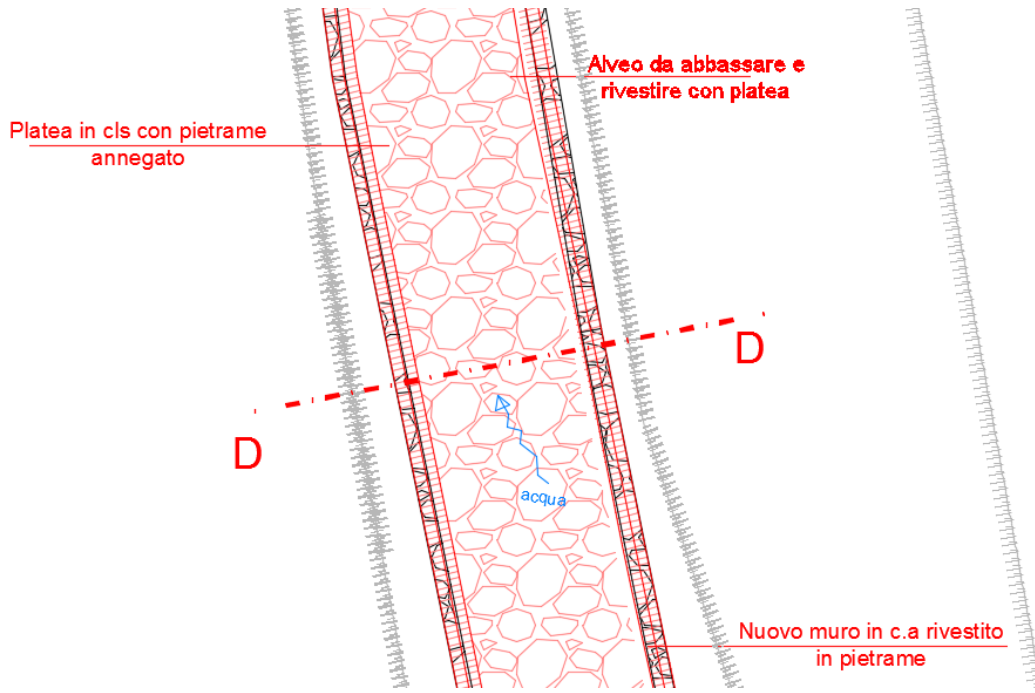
planimetria e sezione di progetto di parte degli interventi nella zona B
